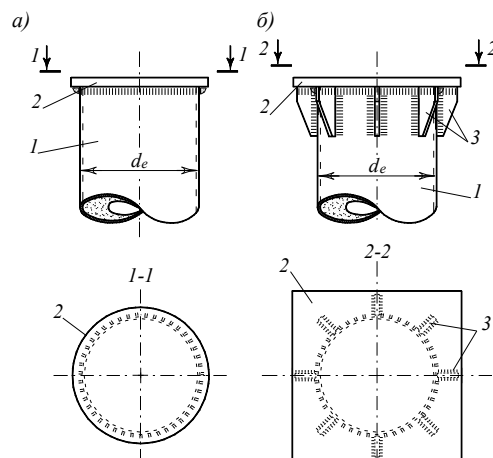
Оголовки центрально сжатых трубобетонных колонн простого типа (а) и с развитой площадью опирания (б): 1 – стержень колонны; 2 – опорный лист; 3 – косынки
